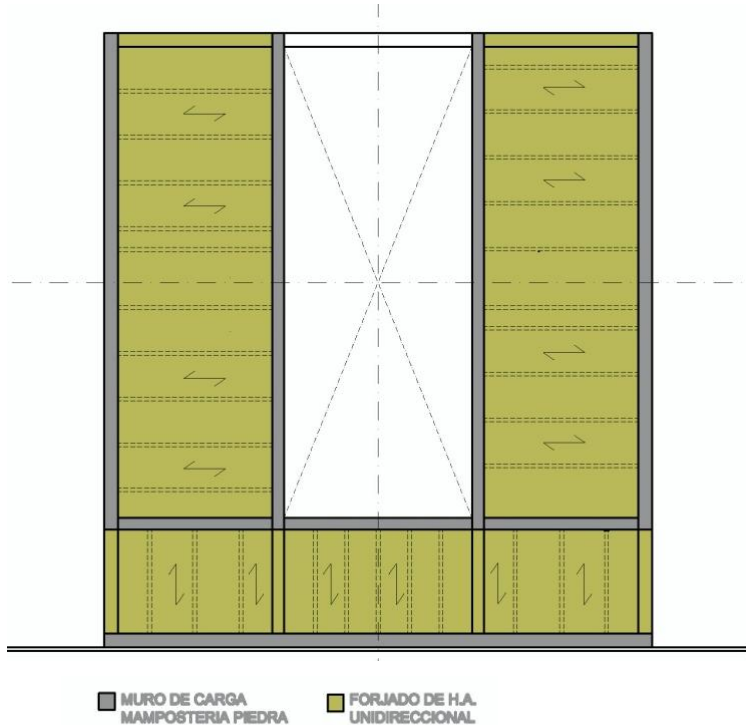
Esquema de estructuras. Forjado cubierta plana, cota +16,10 m. E: 1/200. Levantamiento "in situ" julio 2014. Fuente: el autor
